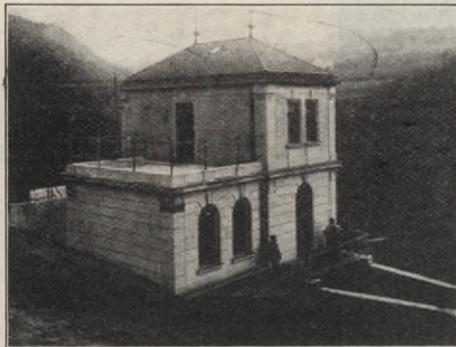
Maschinenhaus der Betzensteingruppe I (Fränkische Schweiz).
